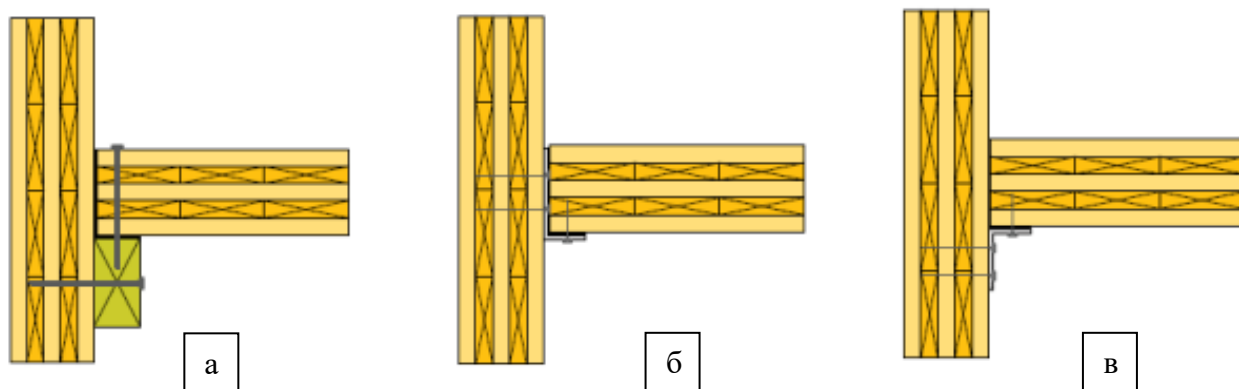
Сопряжение стен с перекрытием (мезонинный этаж):
